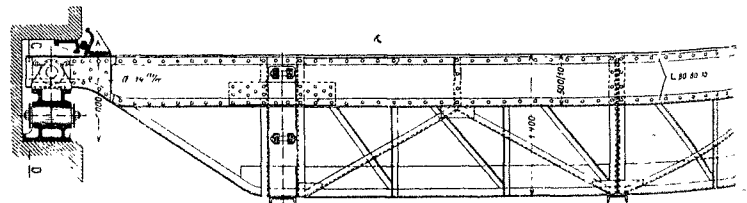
Plan d'une vanne avec son dispositif de roulement et d'étanchéité.
